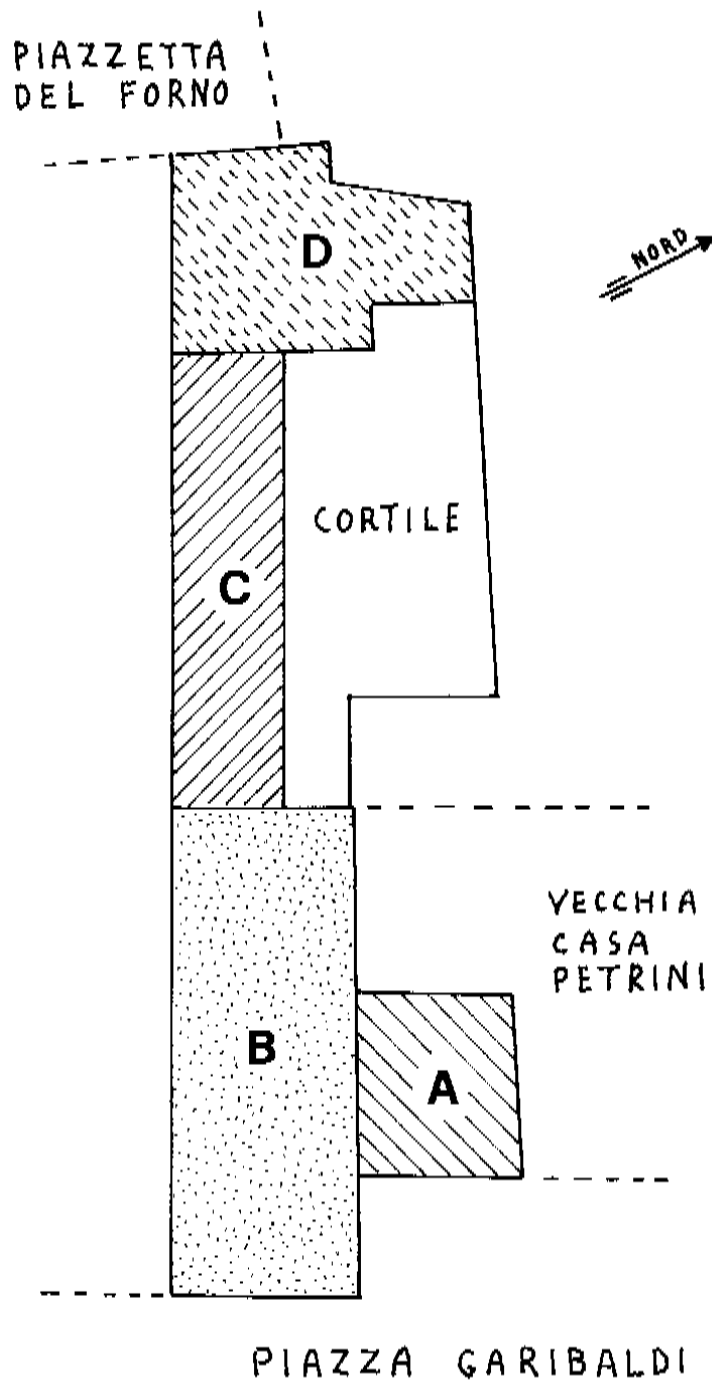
Pianta delle strutture edilizie della Casa Artusi (ricostruzione di T. Aldini).
